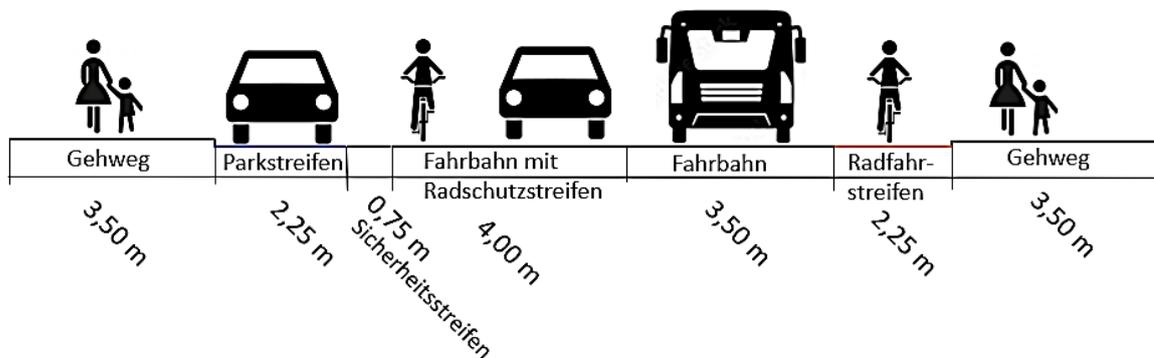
Querschnitt des Straßenraums Parchimer Straße in Variante 2
